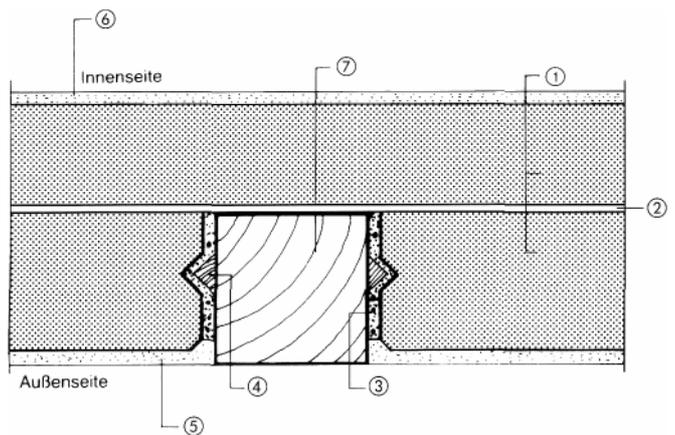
Porenbeton-Ausmauerung mit Innen- und Außenputz
